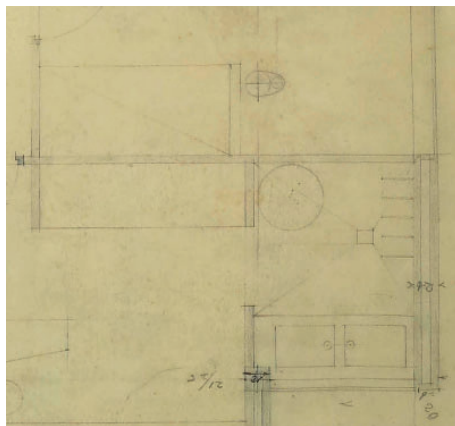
Croquis de la planta baja de la *Villa Savoye* a escala 1:20, Atelier LC-PJ. FLC 19529 (pormenor 1)
